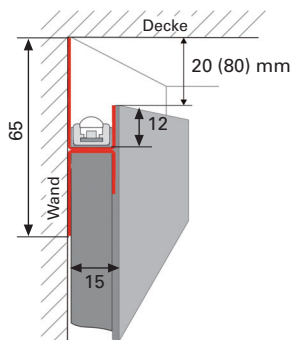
Decken-Lichtvoute mit U/20 oder U/80 Profil Wand-Montage
